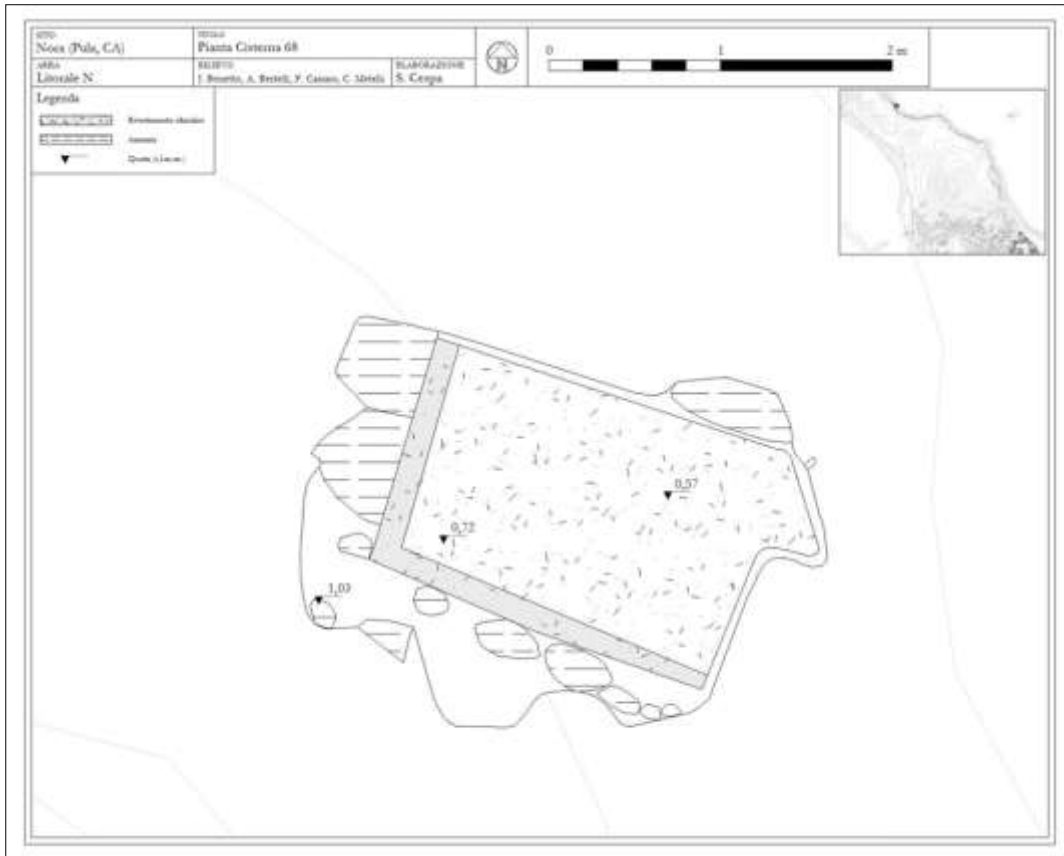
Pianta della cisterna 68 (elaborazione dell'autore).
